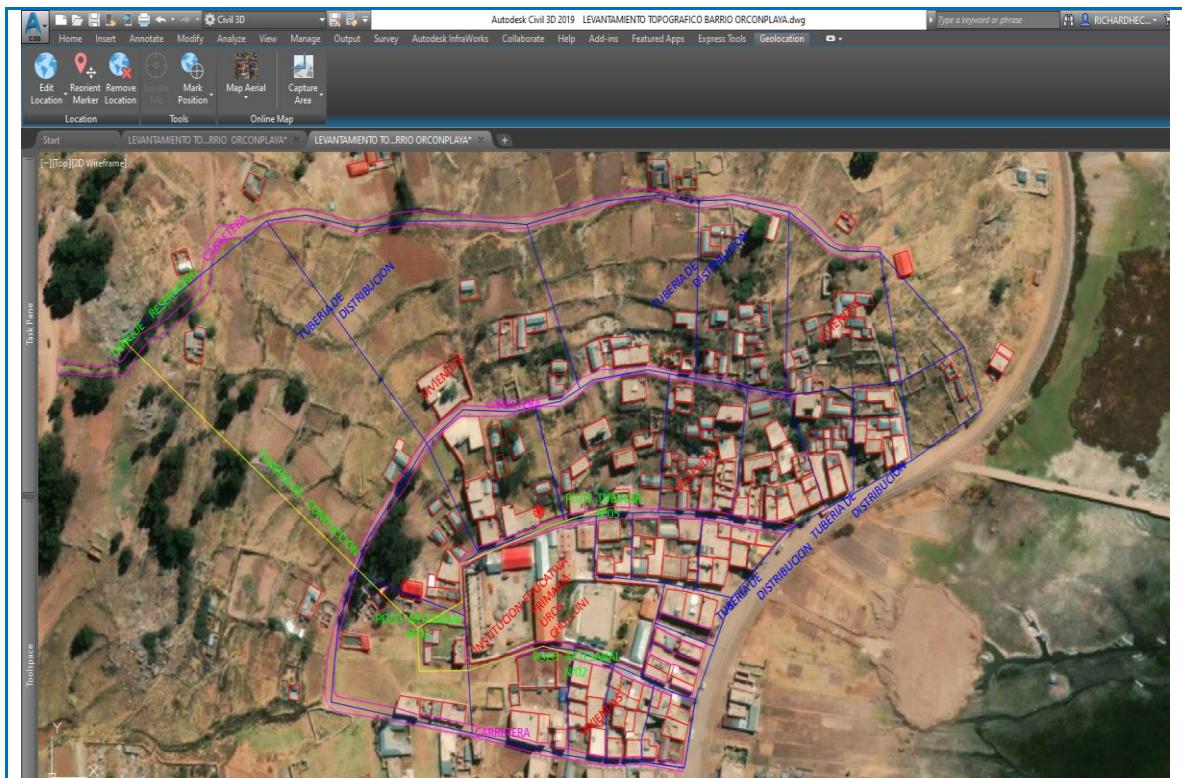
Se aprecia el levantamiento topográfico en civil 3d
